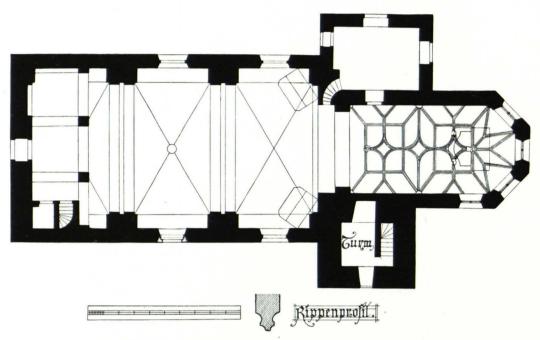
Nöchling, Pfarrkirche, Grundriß 1:250 (S. 125)
